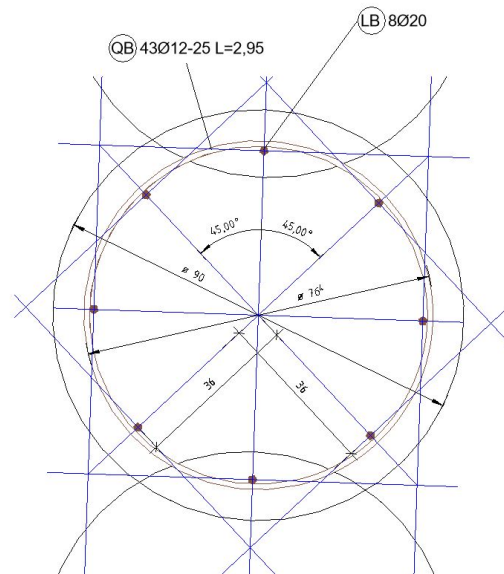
Hilfskonstruktion Bewehrungsmodellierung
